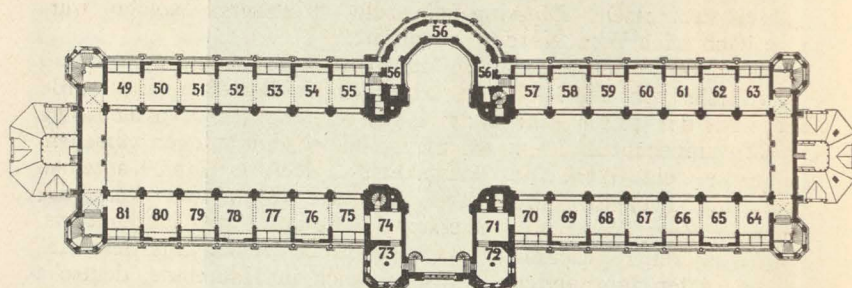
Grundriss des dritten Stockwerkes.
